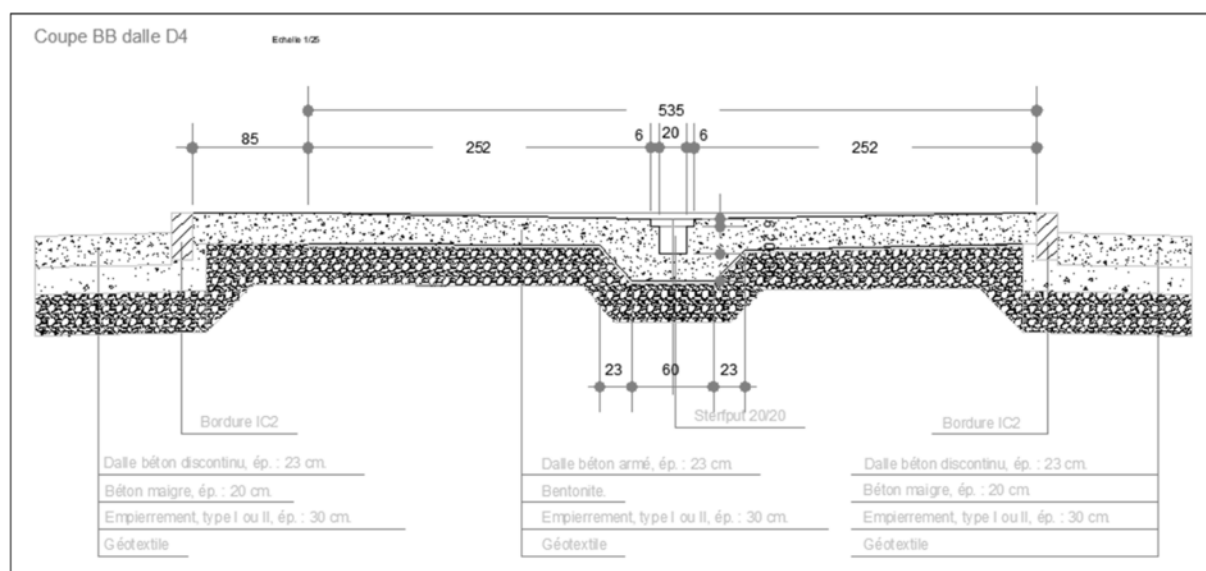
Coupe transversale du revêtement de sol – Plan as built (Pierre Berger, Arcadis, Bureau d'études Hubert Louis, 2009)
